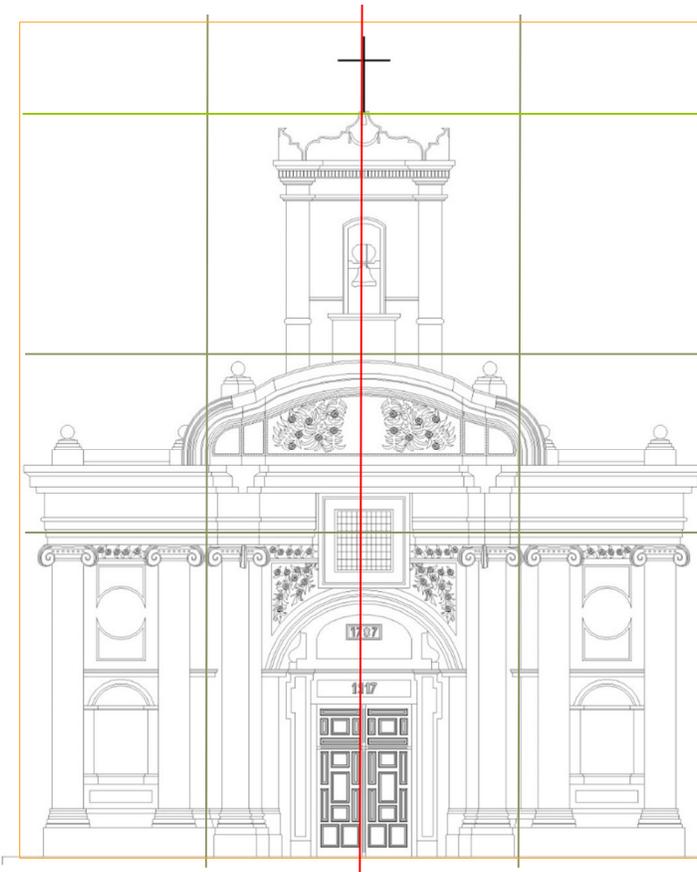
Fachada Santa Rosa. Sin escala. Elaboración propia.
